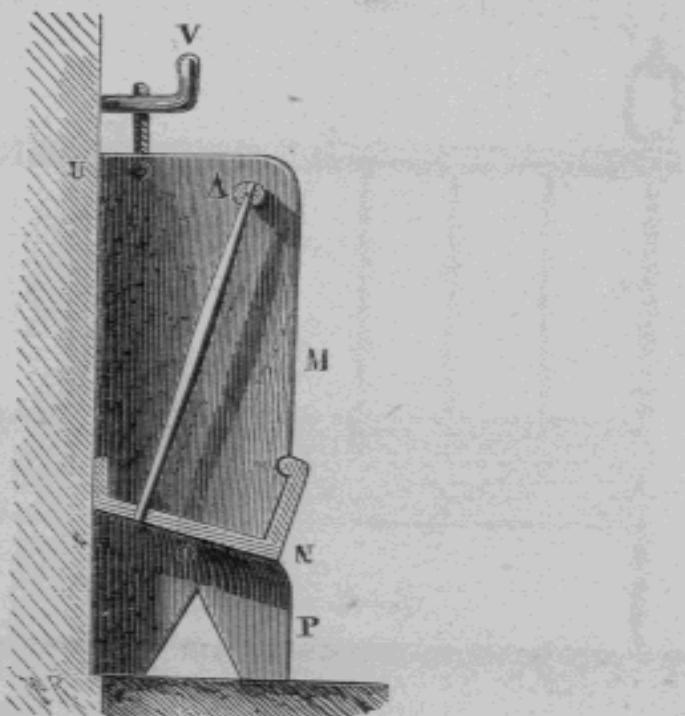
Coupe transversale de la crèche en planches, système Grandvoinnet.
